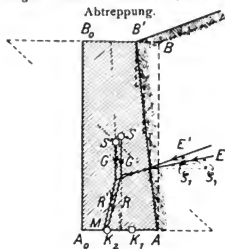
Trapezförmiger Querschnitt mit geneigter hinterer Wandfläche, bzw. mit Abtreppung.
